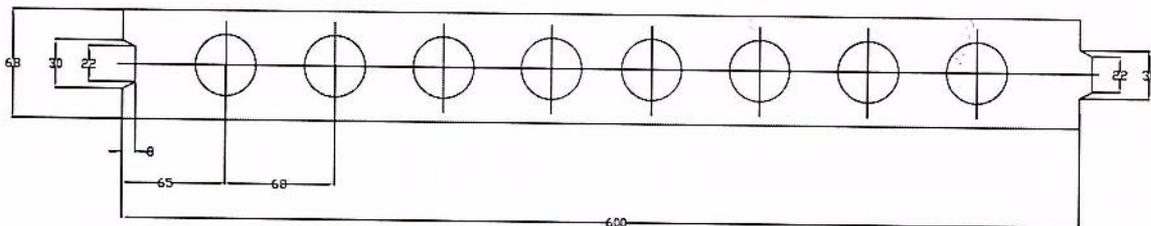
Detalle constructivo del panel WSG 68 (aportado por el peticionario)
